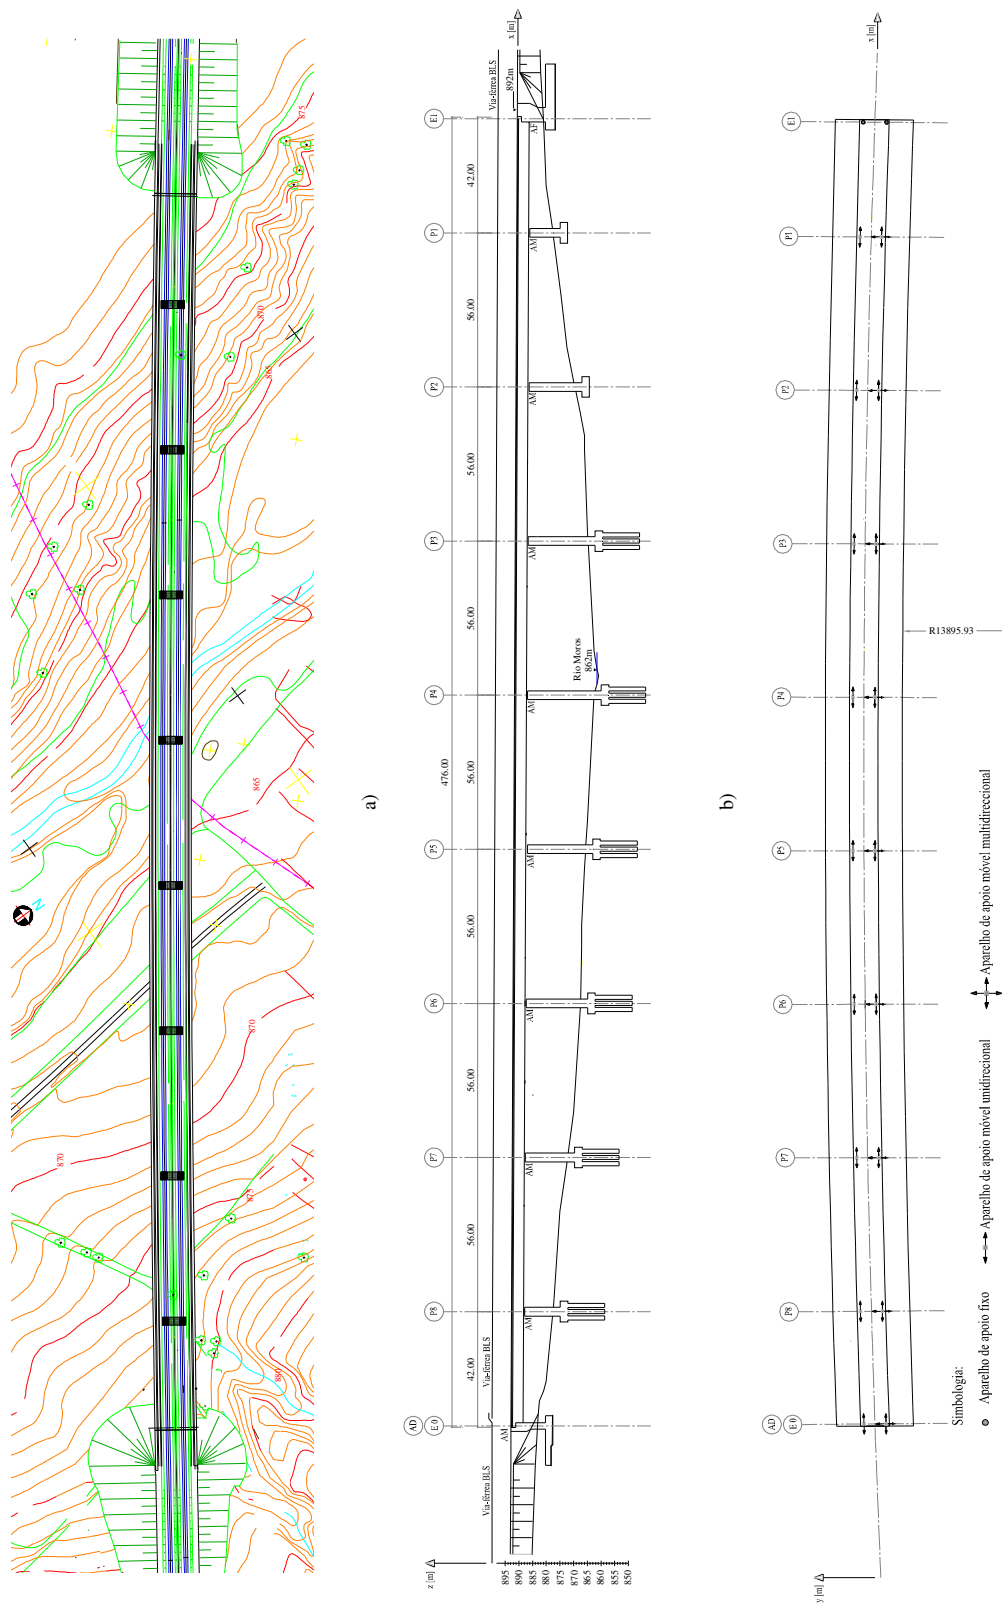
Viaduto sobre o rio Moros: a) planta geral, b) alçado e c) planta dos aparelhos de apoio (adaptado de Parra (2005))
